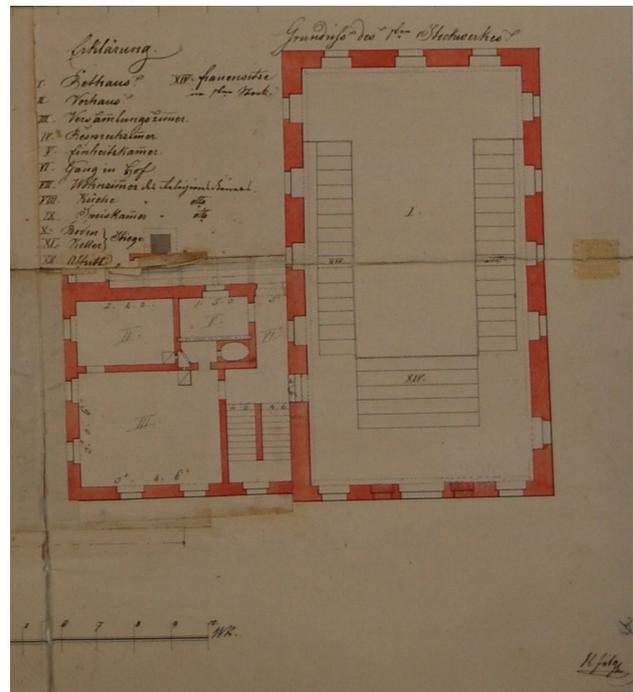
Grundriss 1. OG (ohne rechten Anbau)
